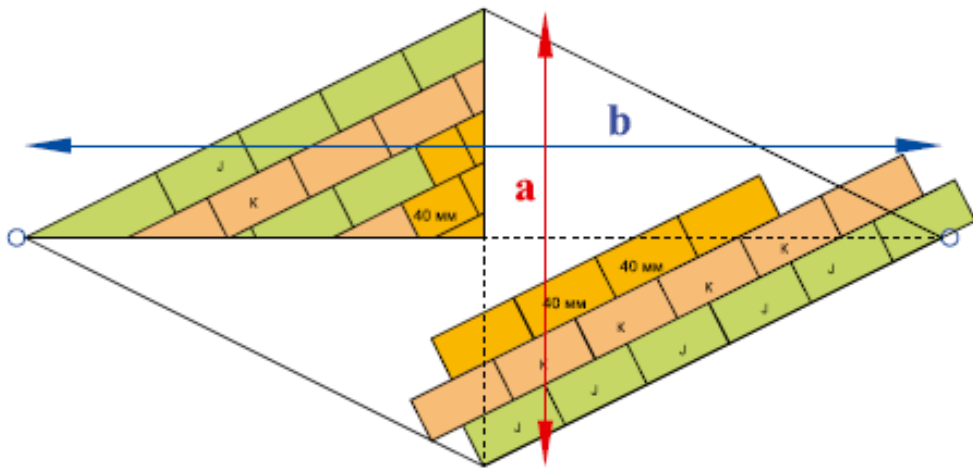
Схема розкладки плит похилоутворюючого шару між воронками в розжолобку
